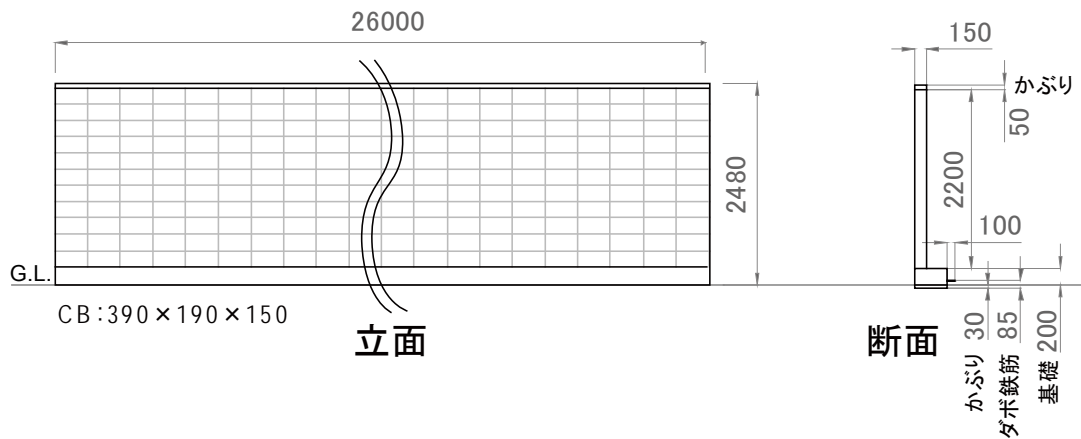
K 真珠前駐車場の CB 塀 立面・断面図 (単位: mm)
